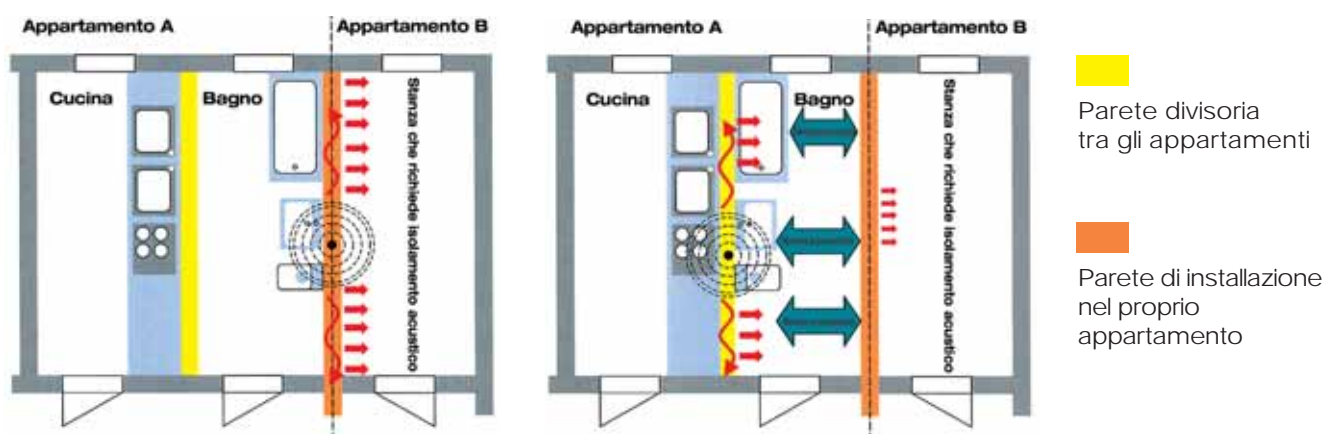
Esempio di planimetria vantaggiosa dal punto di vista acustico
